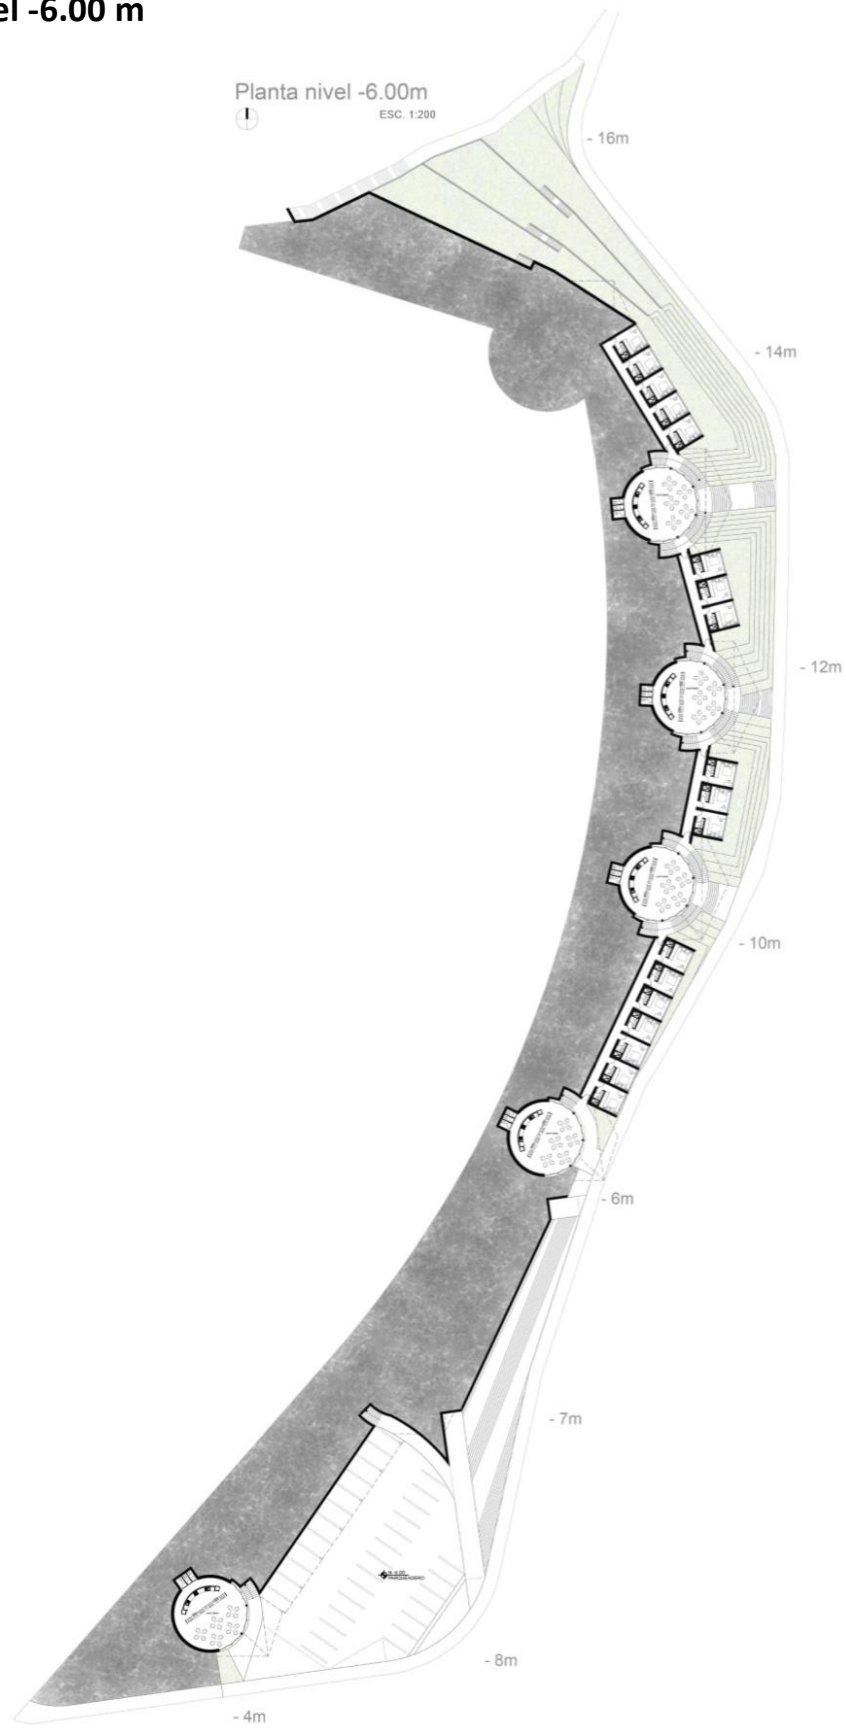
Planta Nivel -6.00 m de la Residencia de Artistas en San Juan.
